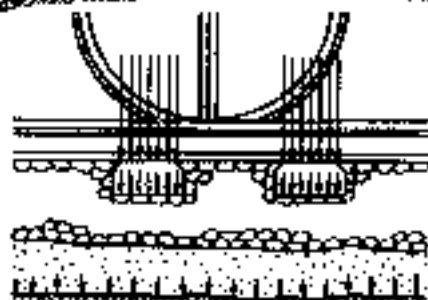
Схема передачі навантаження від коліс на різні елементи верхньої будови колії
